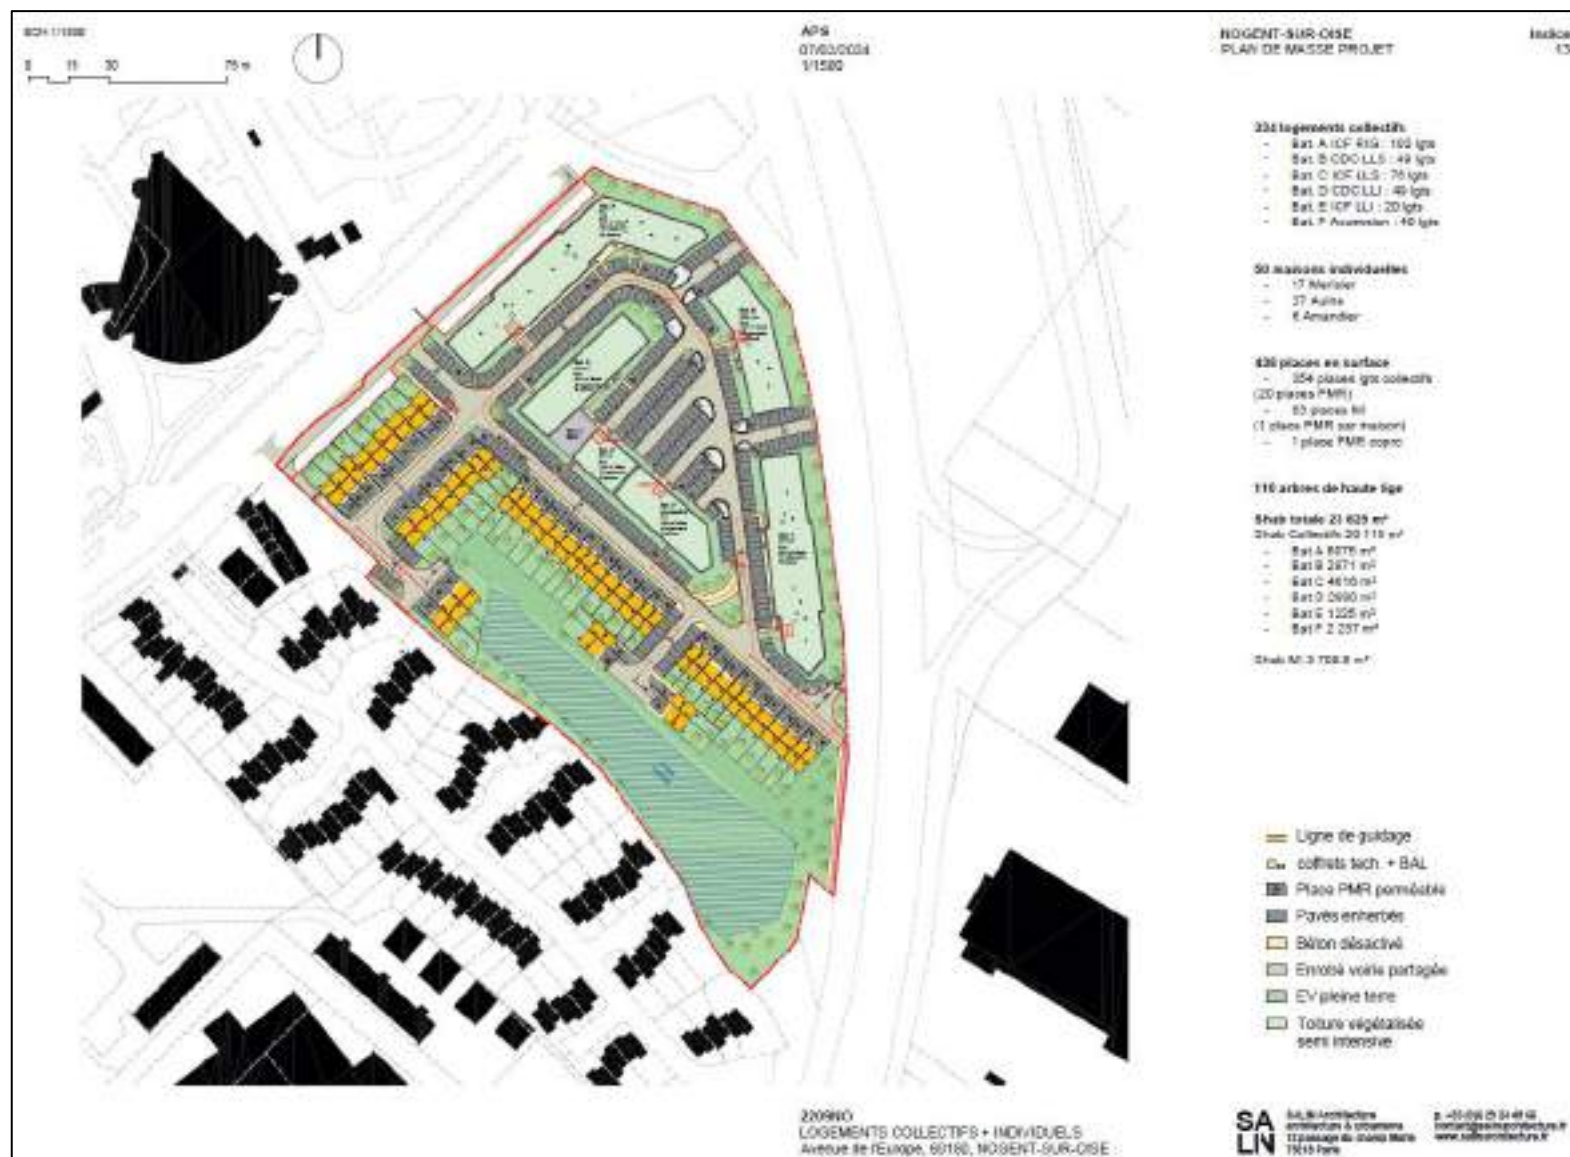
Dernière version du plan de masse (source : SALIN Architecture, 09/02/2024)
